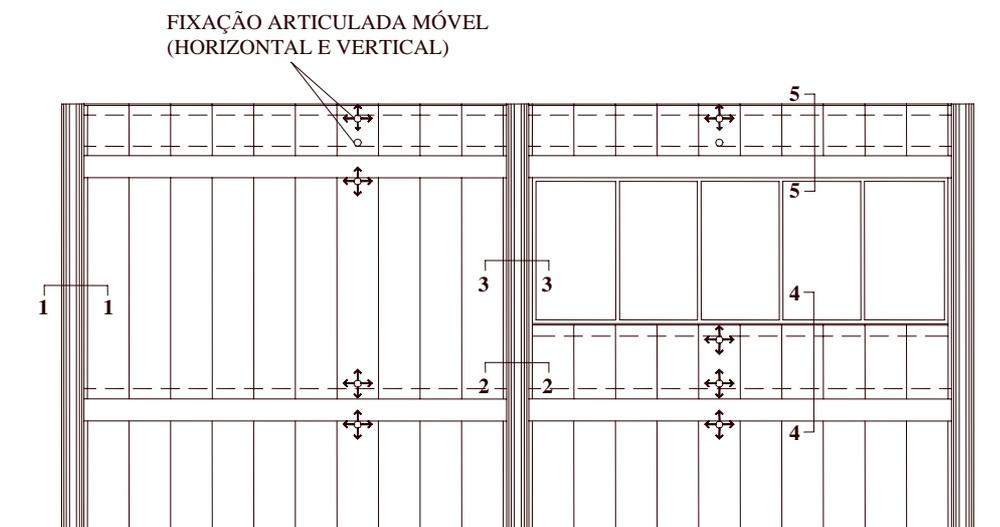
Elevação típica de um fechamento com painel em concreto celular autoclavado.
